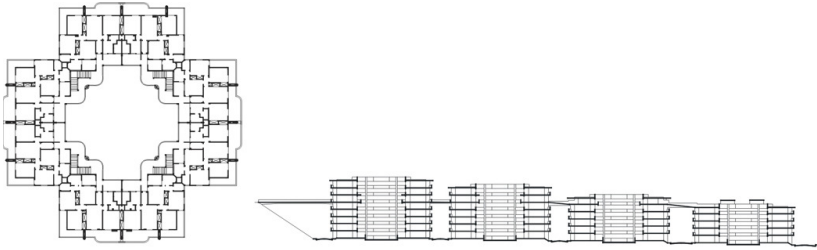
a) Planta baixa do pavimento tipo. b) Fachada do Conjunto Lagoinha. Fonte: Koury; Bonduki; Manoel (2003).
